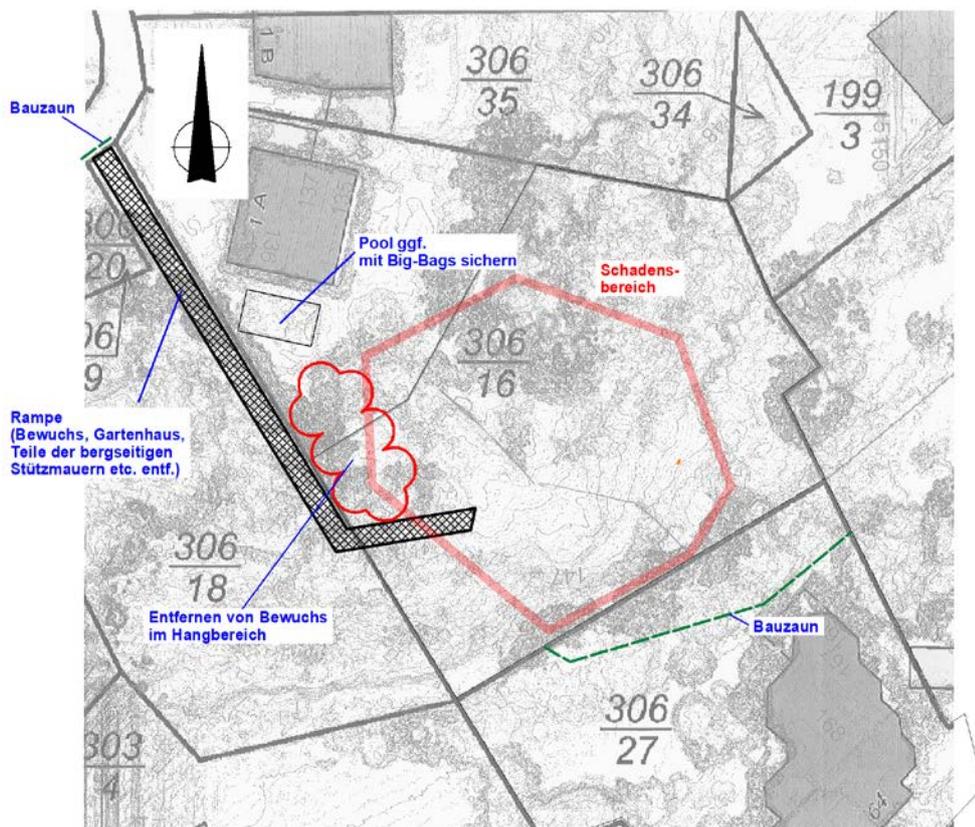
Lageskizze zur Baustelleneinrichtung, Variante B
